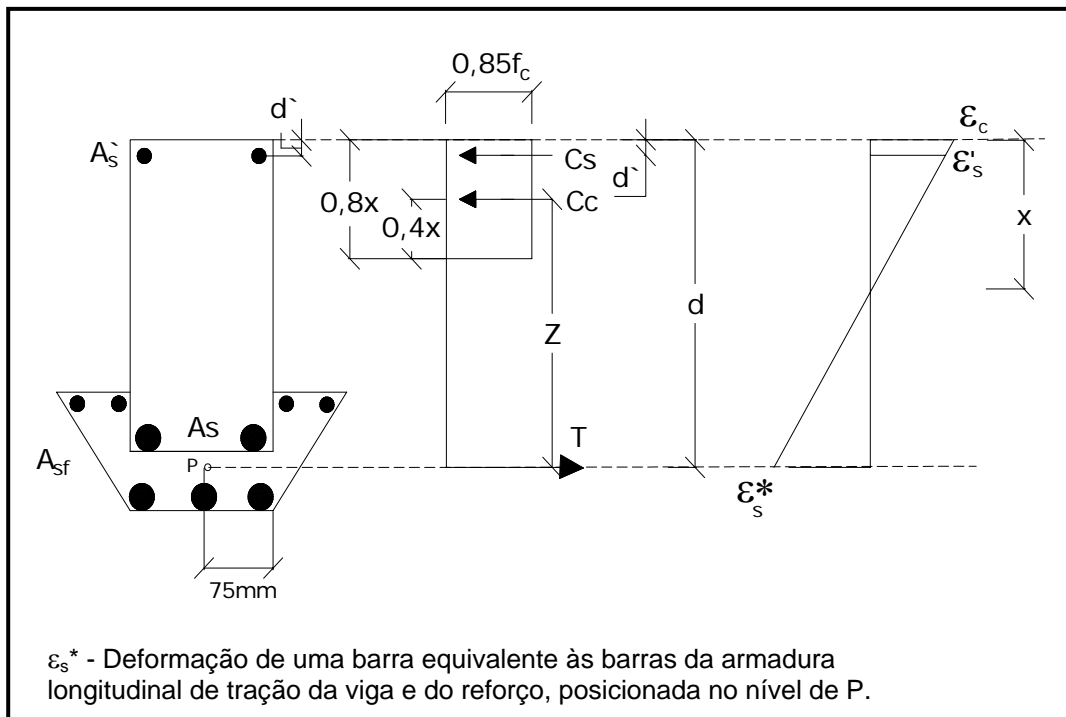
Diagrama retangular simplificado de tensões e diagrama de deformações da seção da viga reforçada.
